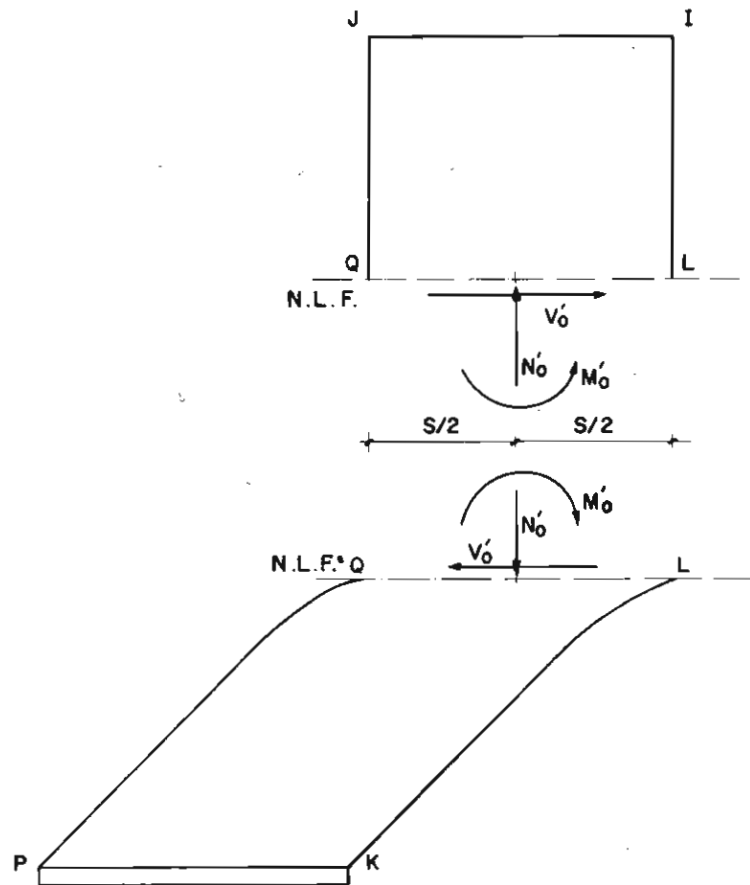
Momento resultante y fuerzas en el plano del nivel límite de fisuración.
